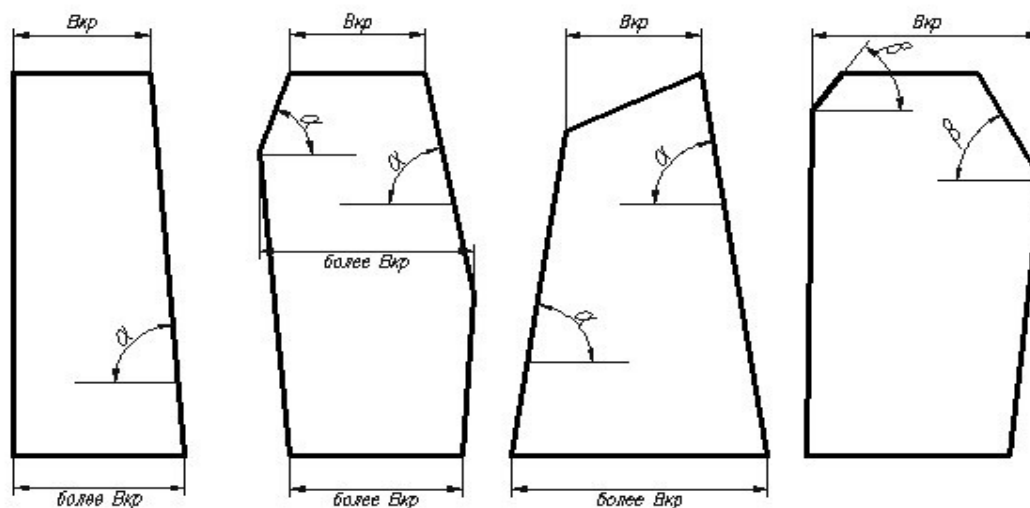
Схемы расположения базового и предлагаемого варианта для угла 15°.
